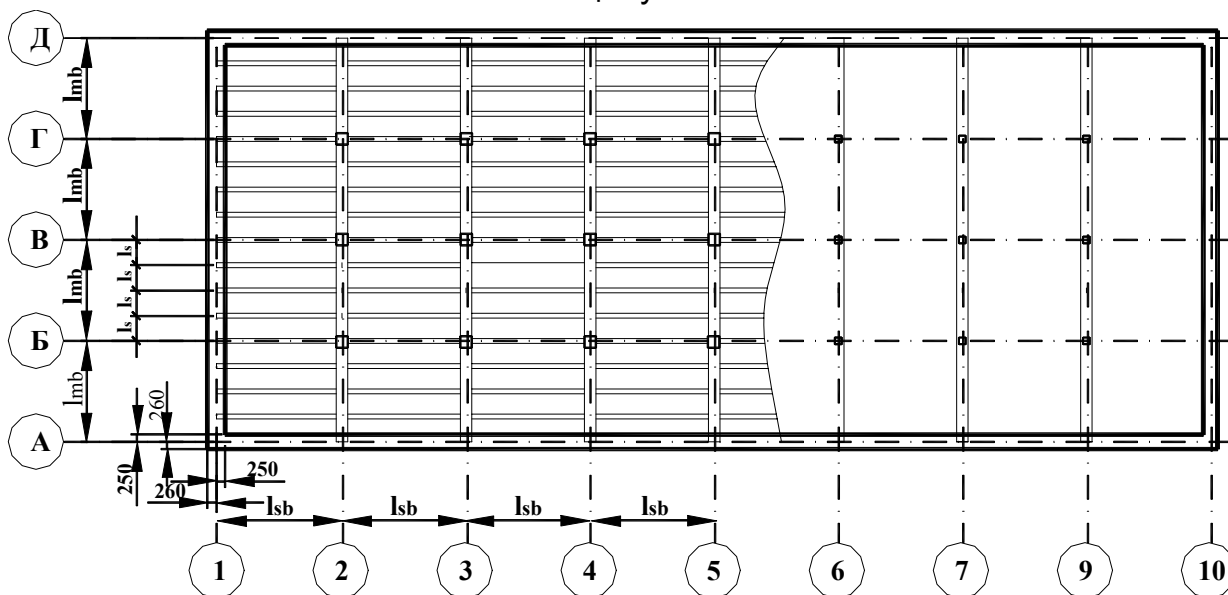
К назначению размеров пролетов и поперечных сечений элементов монолитного перекрытия.
